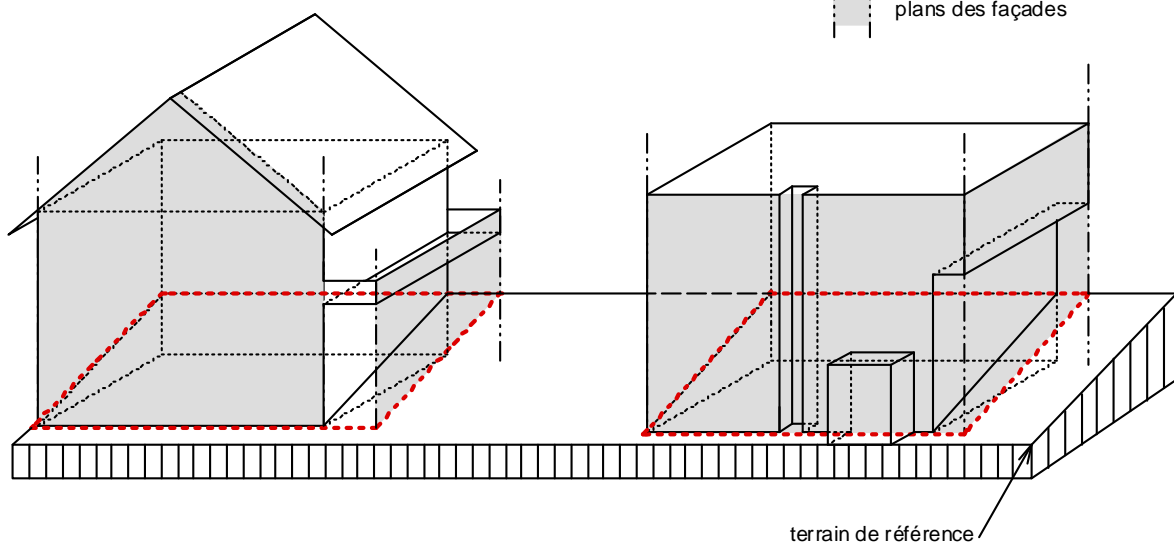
3.3 Plans des façades et projection du pied de façade
